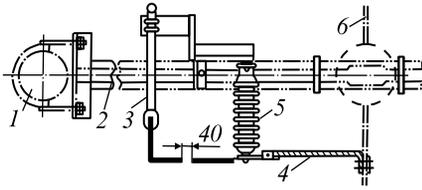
Расположение трубчатого разрядника на опоре: 1 — опора; 2 — кронштейн; 3 — разрядник; 4 — электрический соединитель; 5 — изолятор; 6 — провод ВЛ
